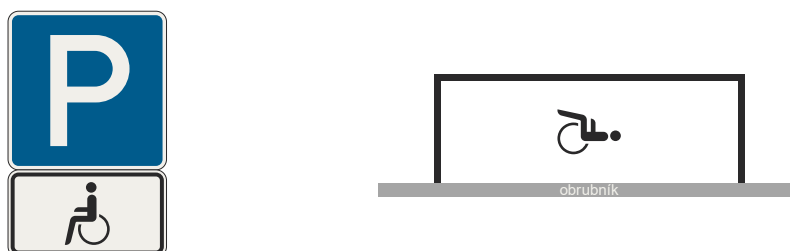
Označovanie viacerých vyhradených parkovacích miest
